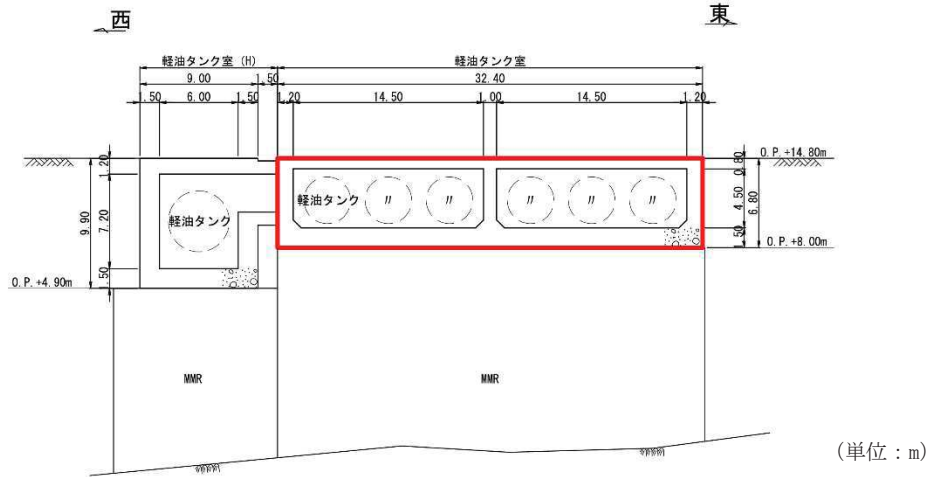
軽油タンク室断面図 (B-B 断面, 東西 (タンク室))
